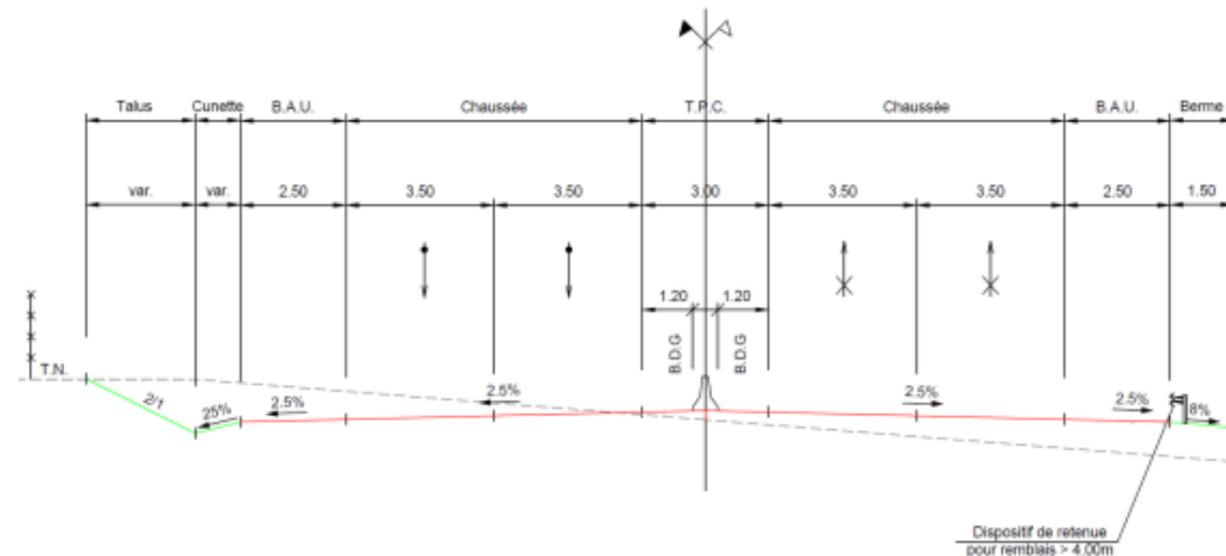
Profil en travers type de l'A150 Barentin / Ecalles-Alix
